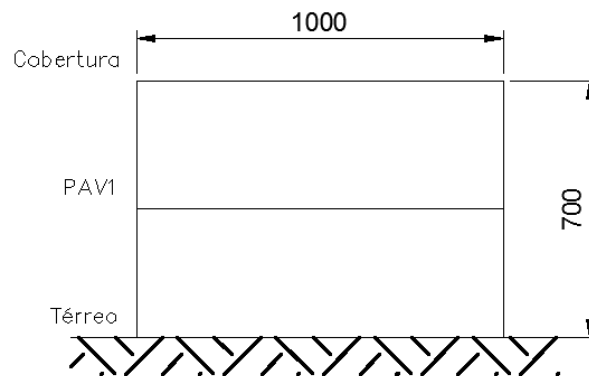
Vista transversal da edificação da fachada posterior (sem aberturas), sem escala, dimensões em cm.
